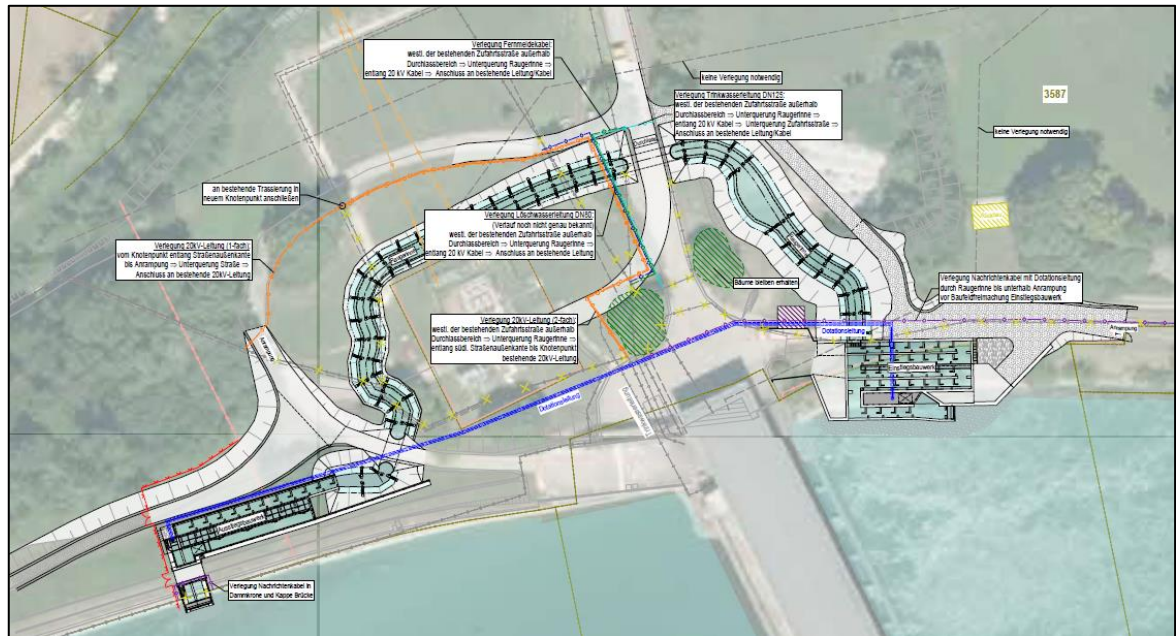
Übersichtslageplan betroffener Sparten und deren geplante Verlegung
